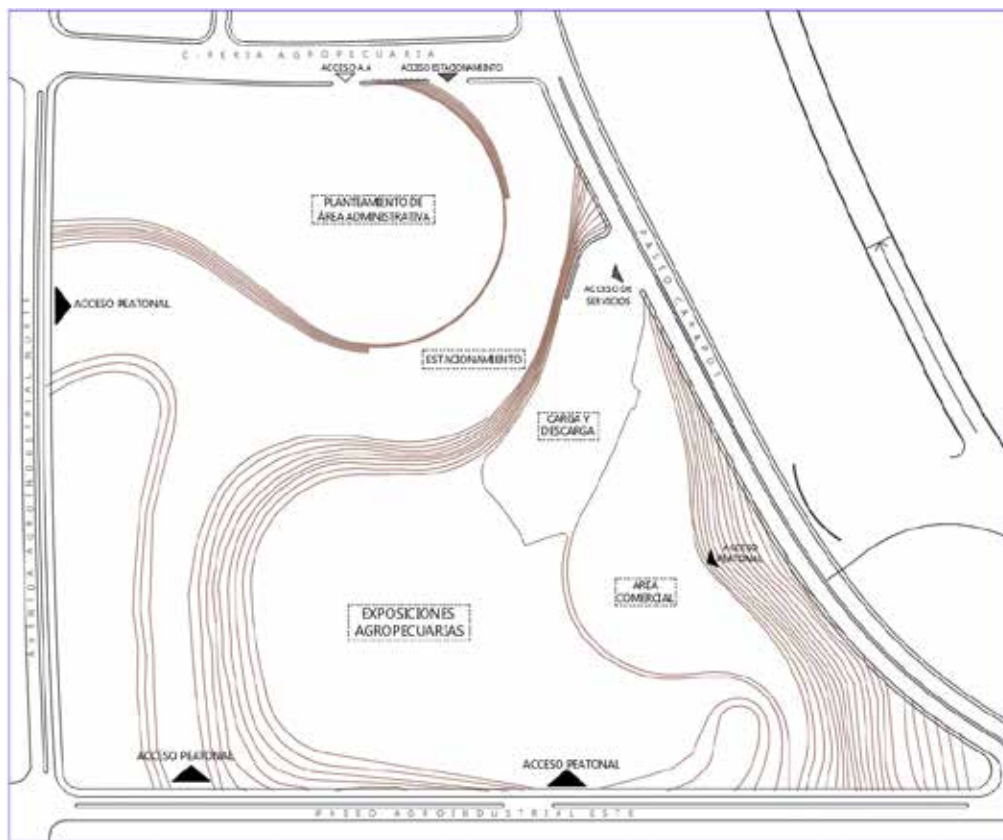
Plano topografía modificada y accesos. La Autora (2020).
